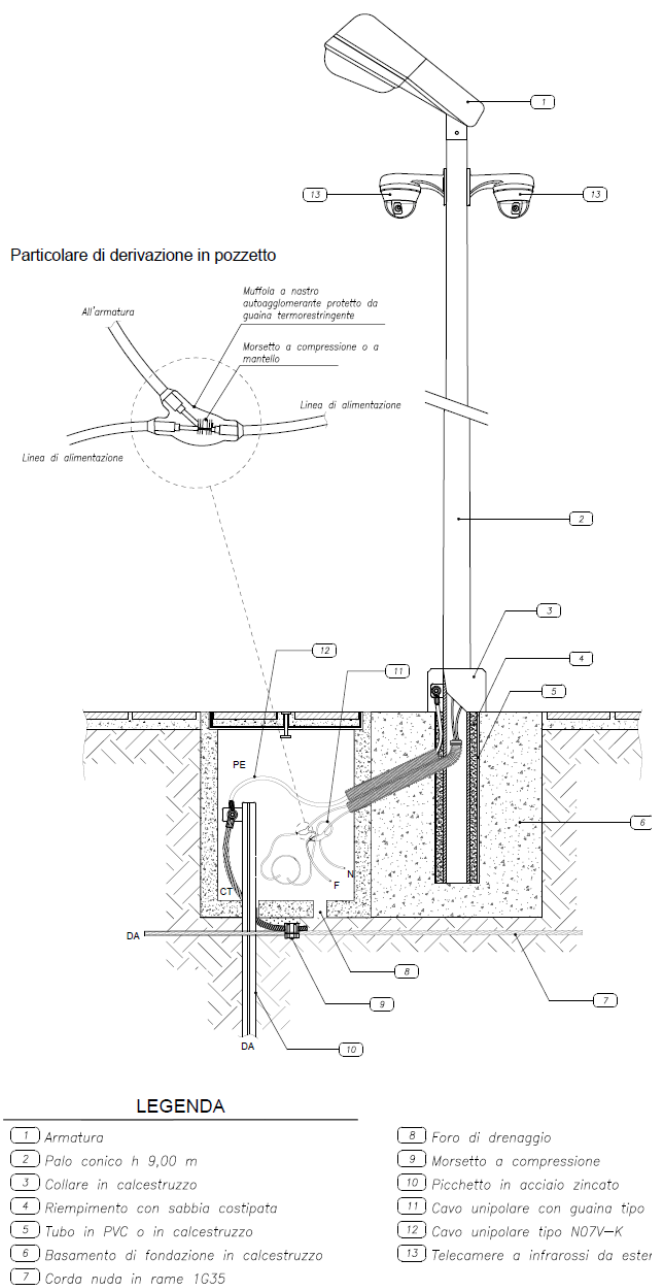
Palo di supporto per corpo illuminante e telecamere
